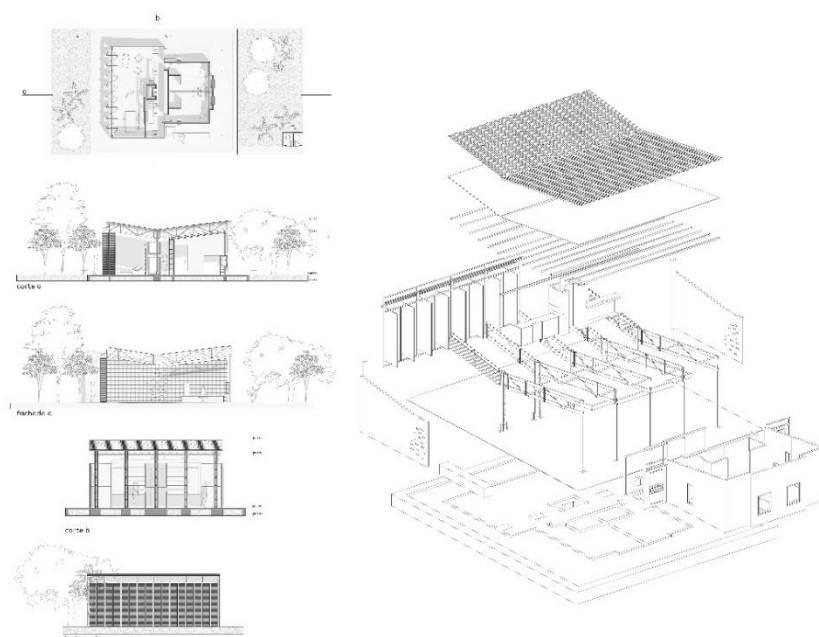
Desenhos finais da casa de Jajja, planta baixa, cortes, elevações e diagrama de perspectiva. Fonte: arquivo pessoal.
